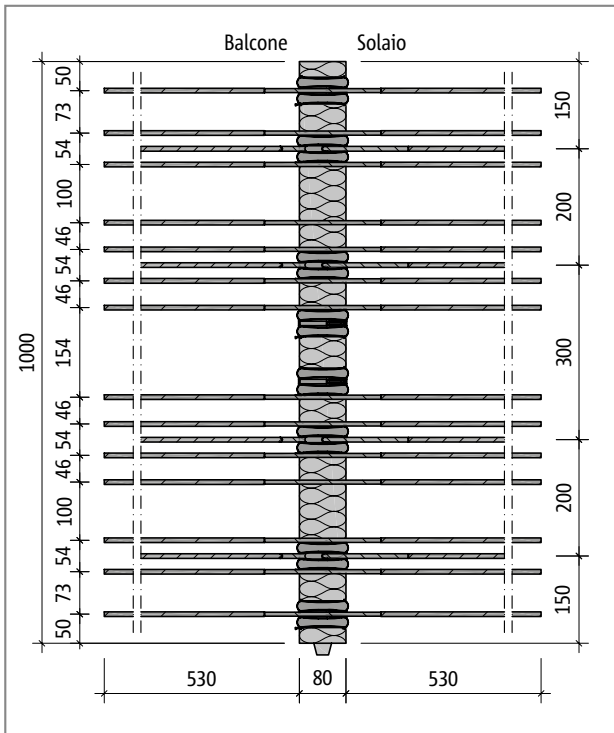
Schöck Isokorb® tipo K50S, pianta del prodotto
